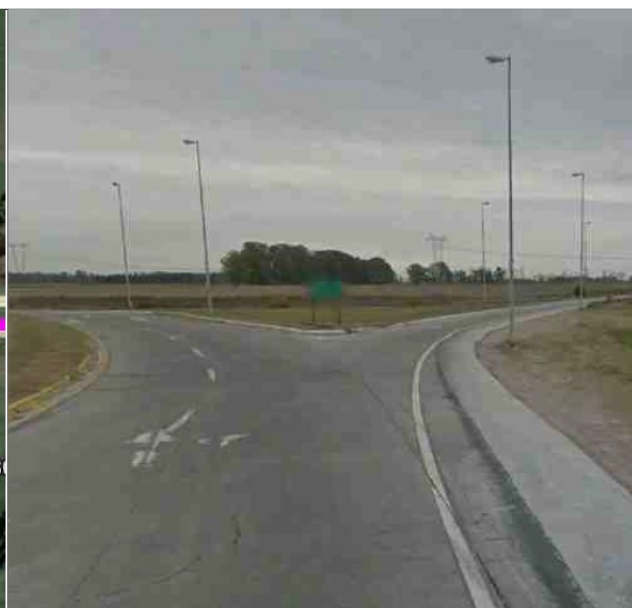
y Foto 201. Intersección RP N°6 con RP N°53
